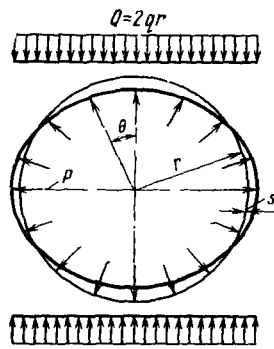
Схема деформирования профиля трубы от веса грунта
